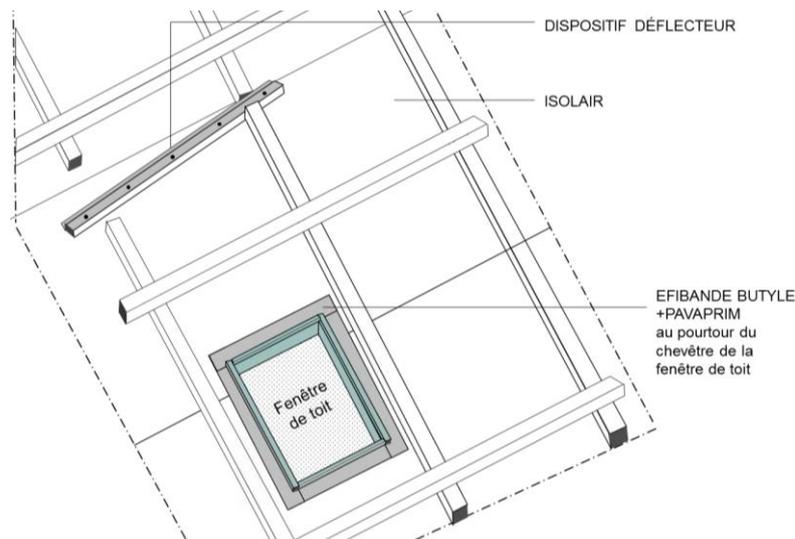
Dispositif déflecteur sur panneau ISOLAIR
